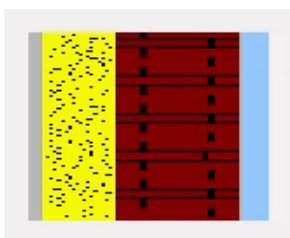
Sección constructiva del muro exterior (Elaboración propia)
